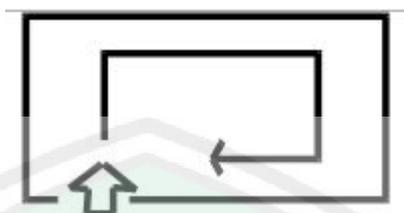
14 Layout ruang koleksi dan ruang baca
